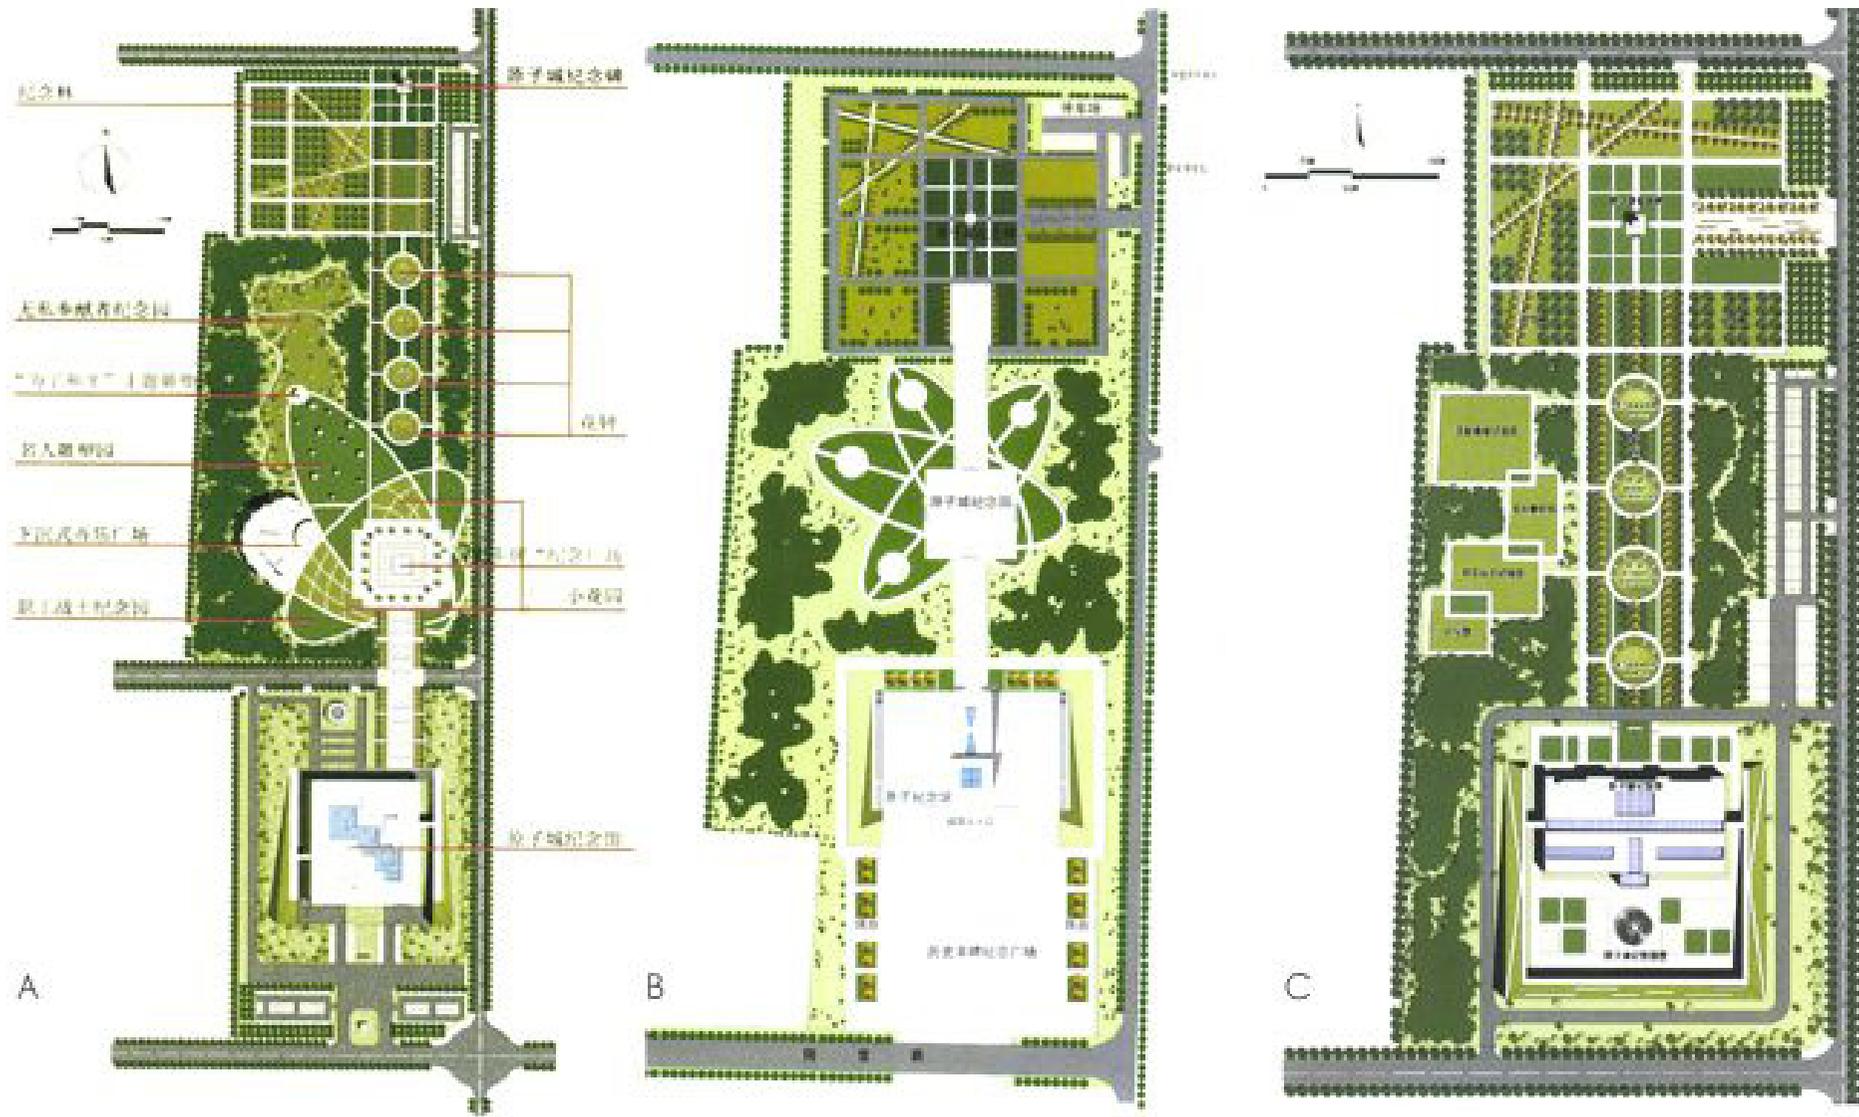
Plan de planificación original de A en abril de 2006, B.Plan 1 en septiembre de 2006, C.Plan 2 en septiembre de 2006, se seleccionó el plan 1 final.(Imagen extraída en red:youthla.org)
